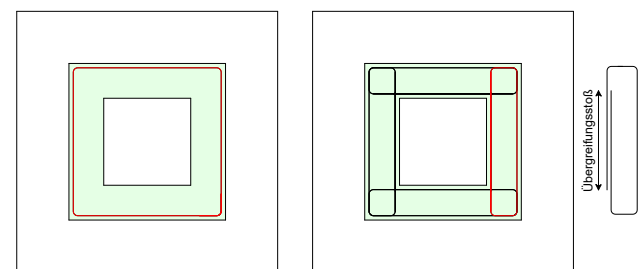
1-schnittig und 2-schnittig je Köcherwand – horizontale Köcherbewehrung
